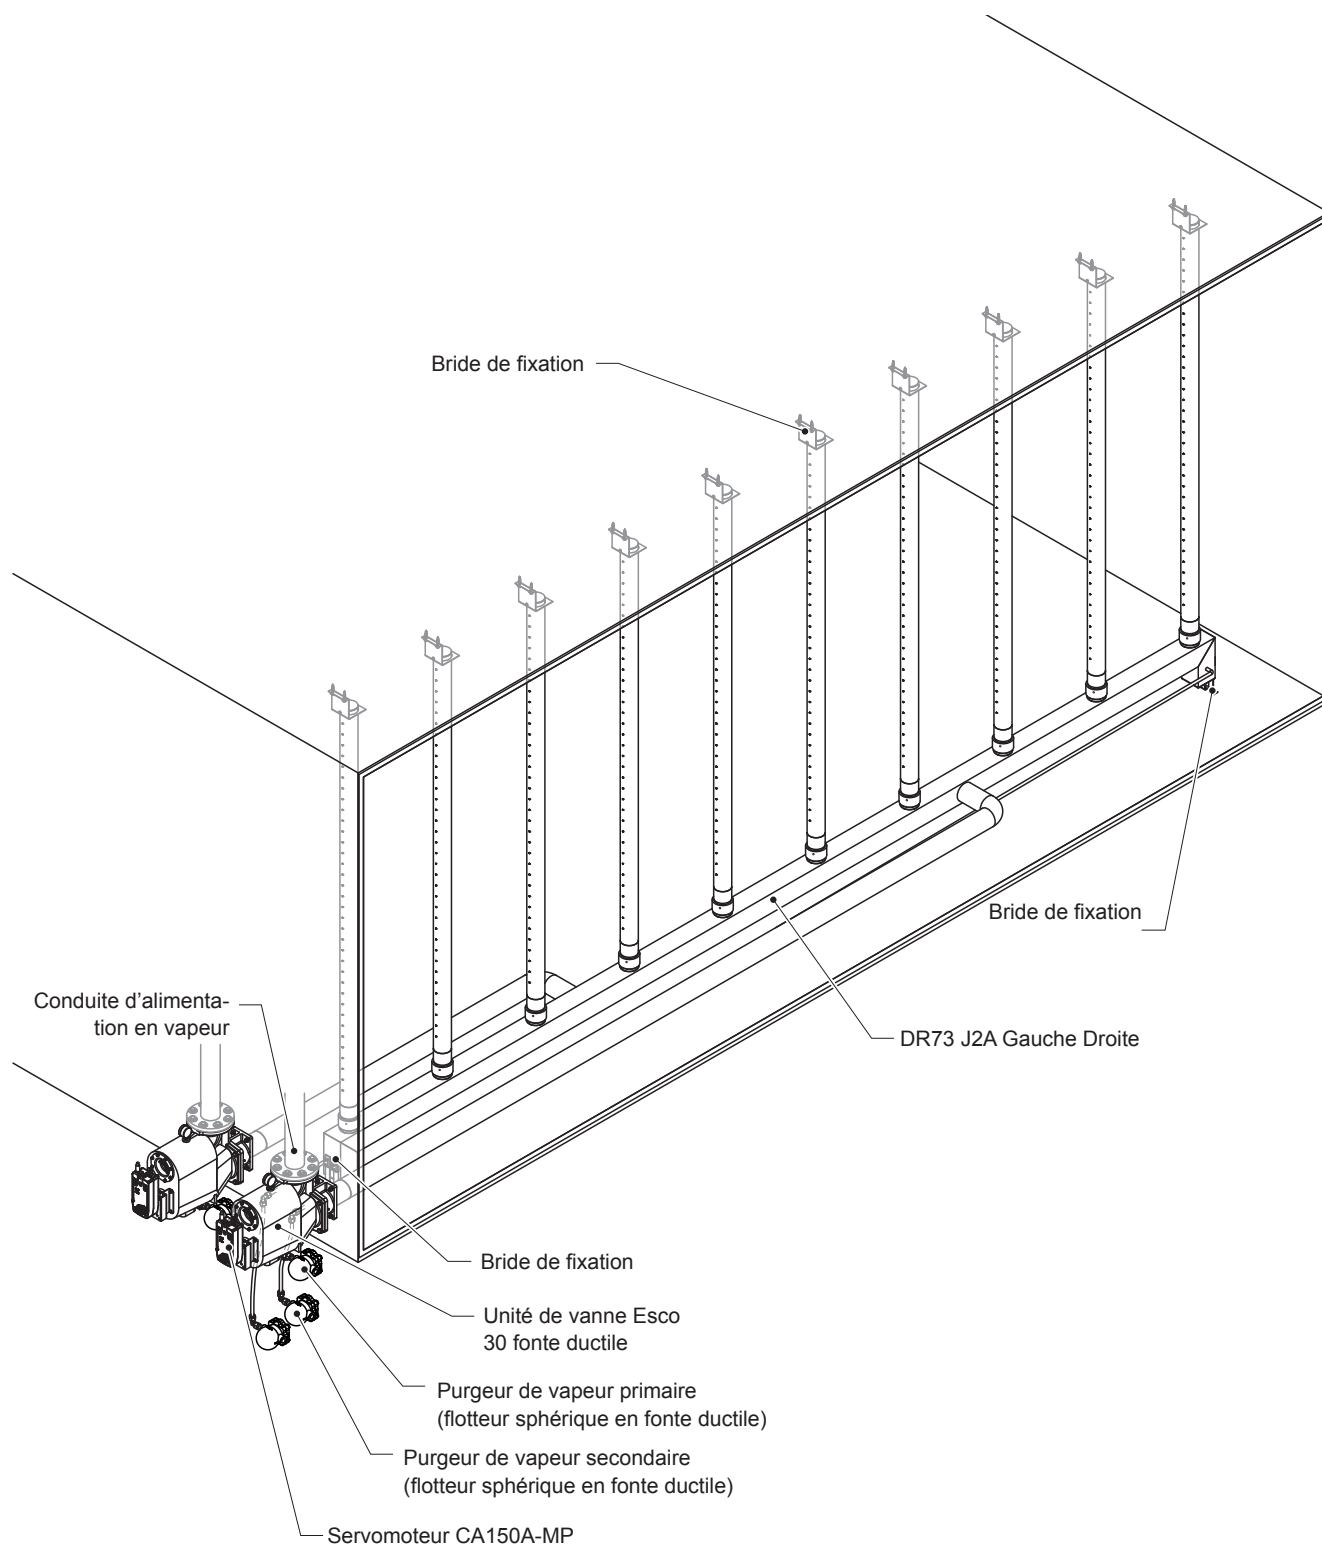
Aperçu d'installation Condair Esco 30 fonte ductile avec DR73 J2A gauche droit
